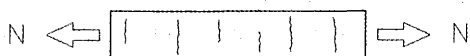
Fisuración por esfuerzo de tracción.
